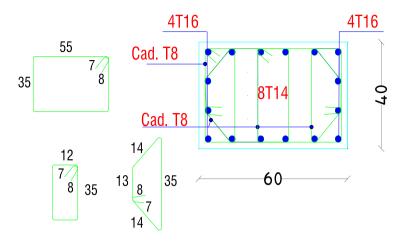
coupe Ferraillage des poteaux (60×40) cm².
